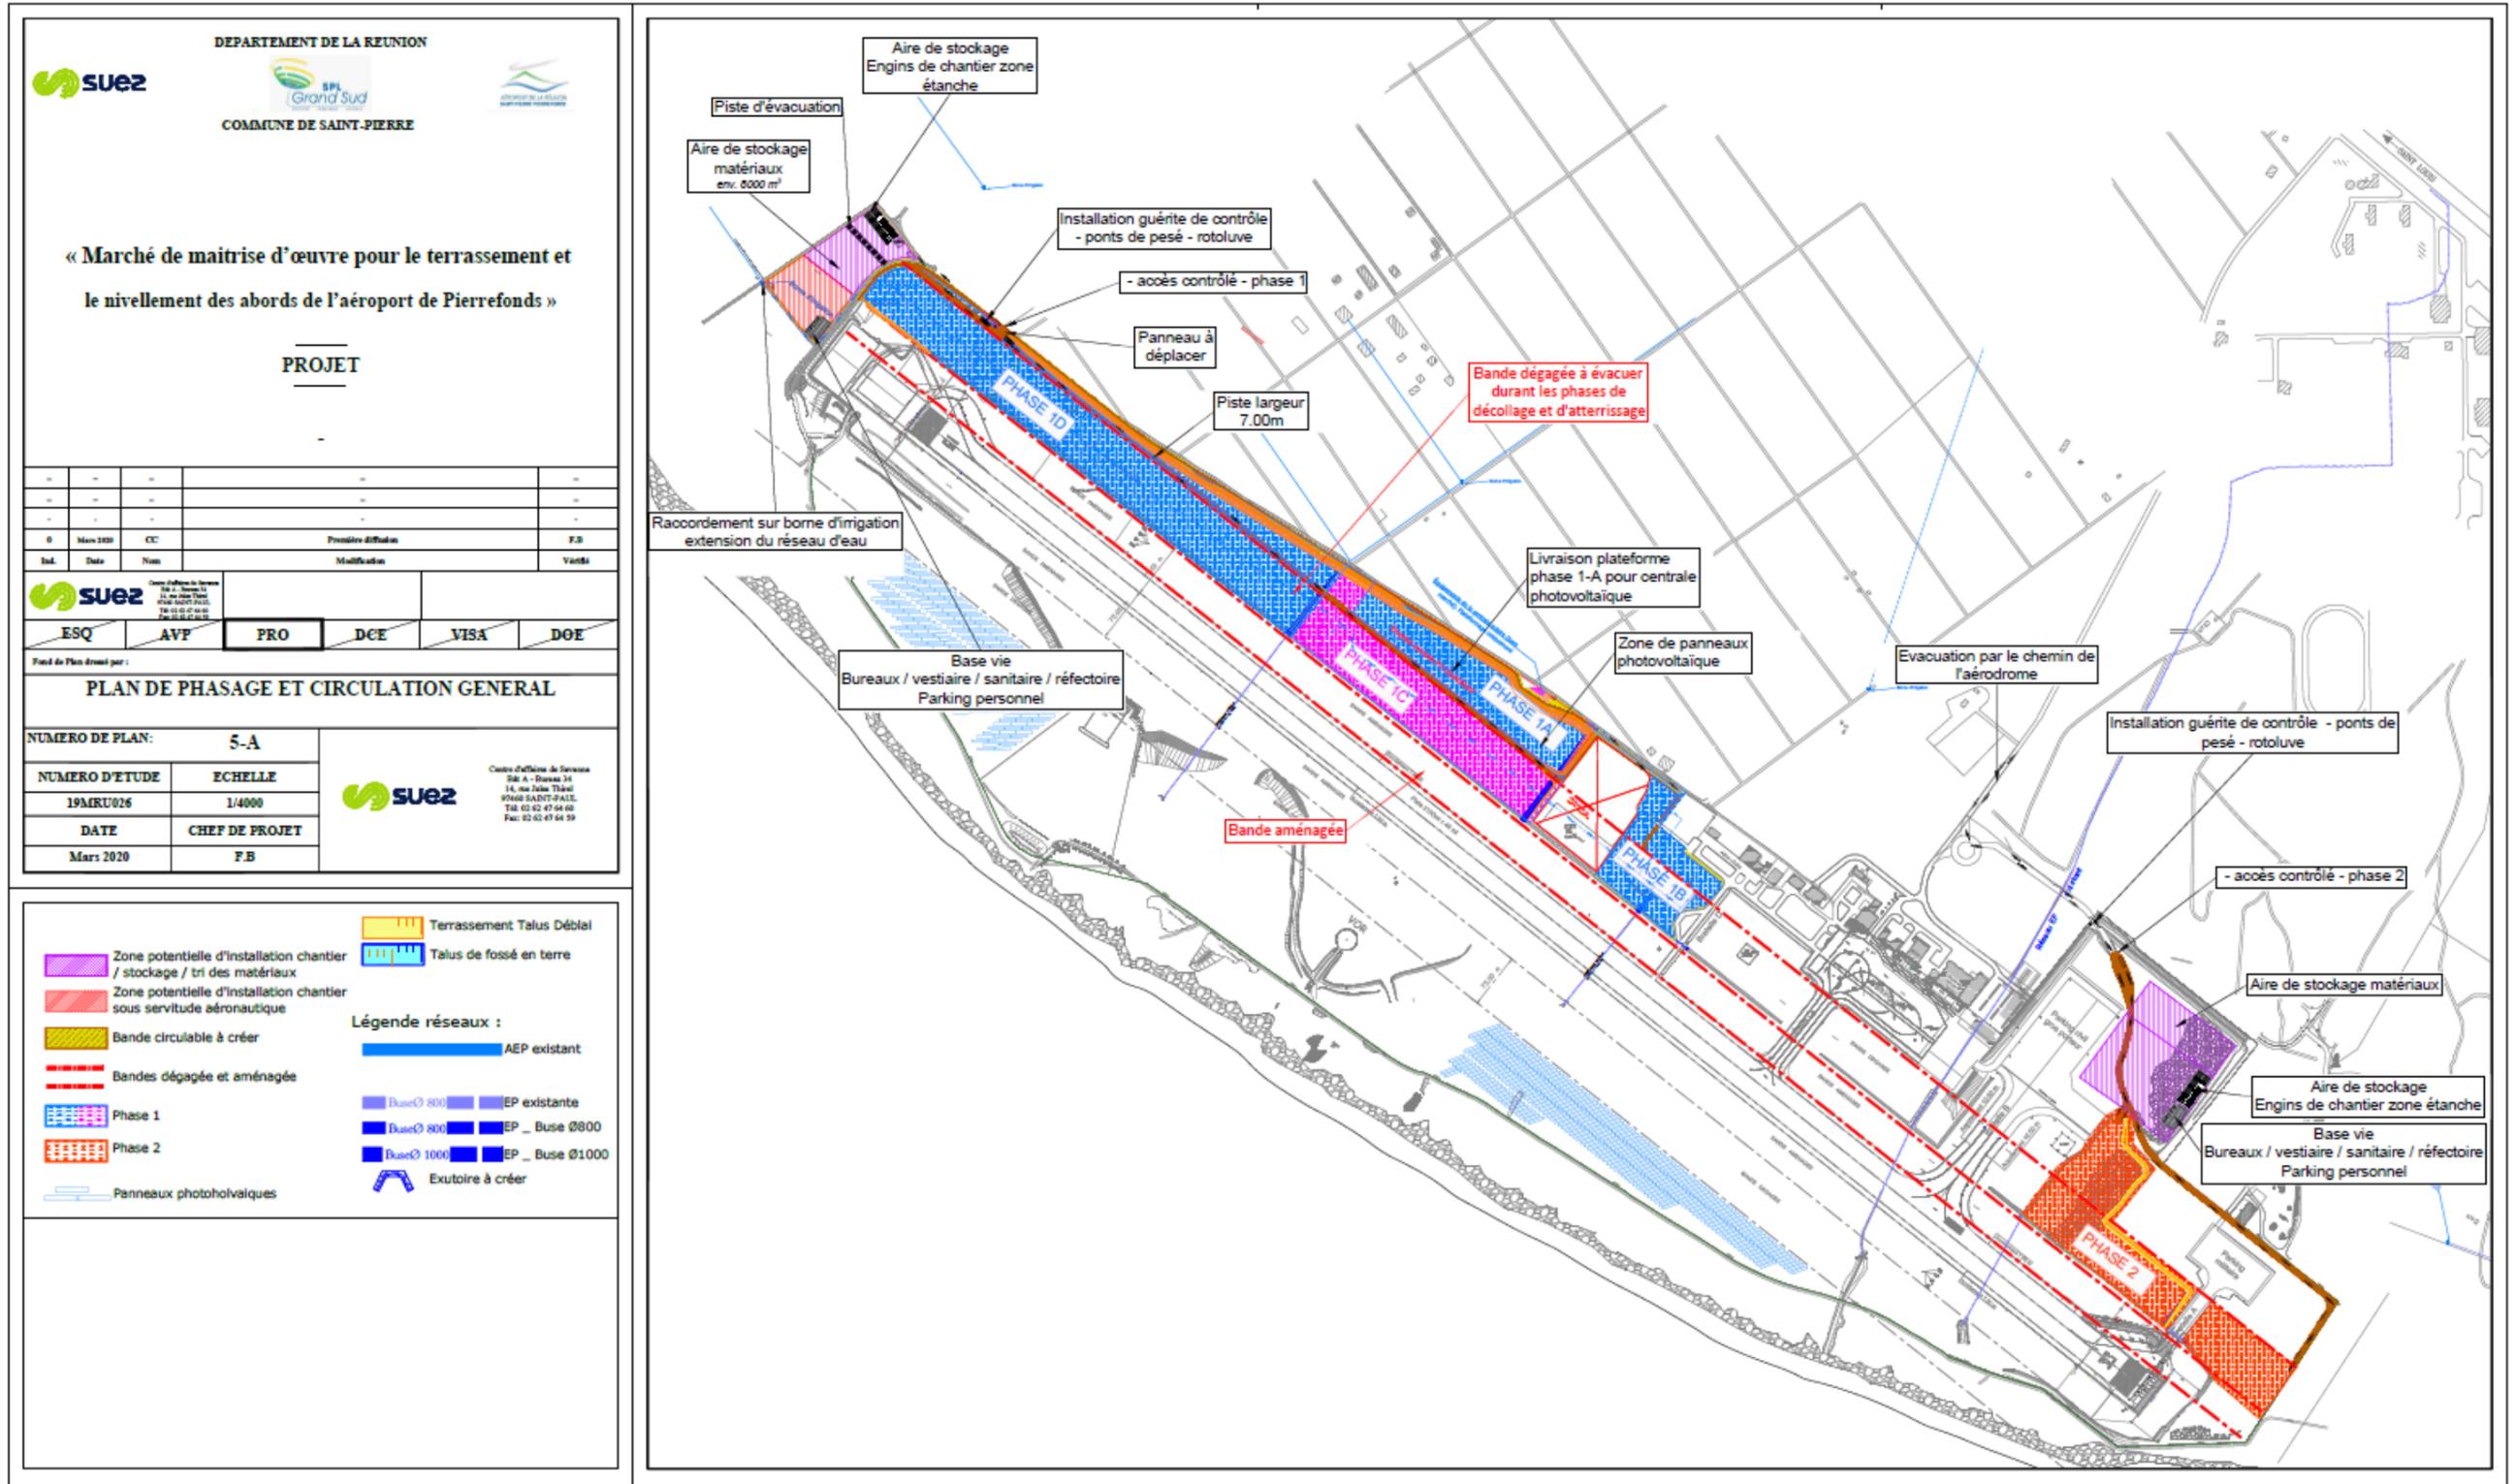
Plan de masse de phasage des travaux (Source : Suez Consulting)
